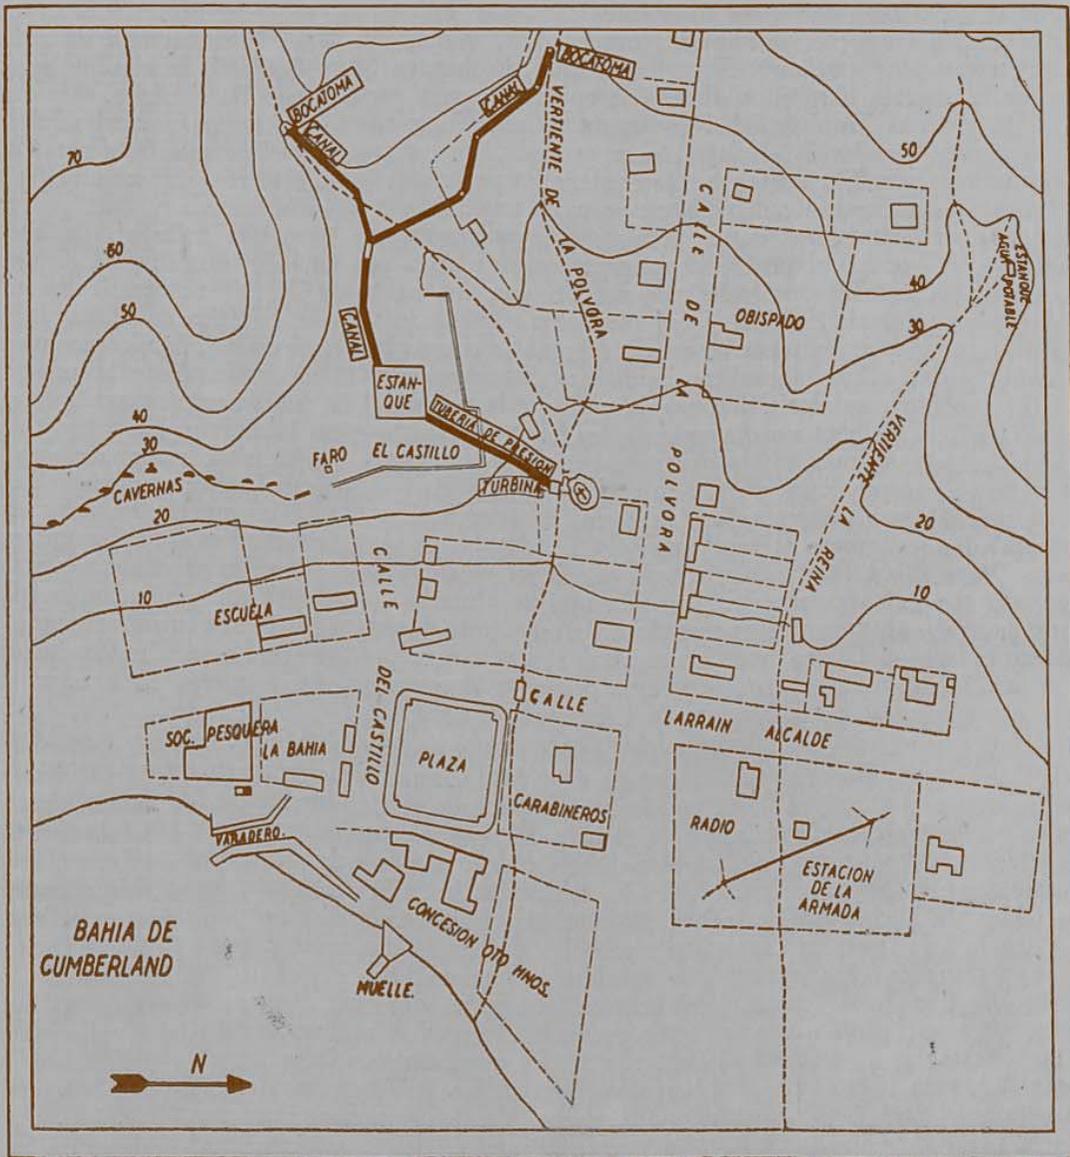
Plano topográfico de parte del pueblo de San Juan Bautista con la proyectada planta hidroeléctrica.
